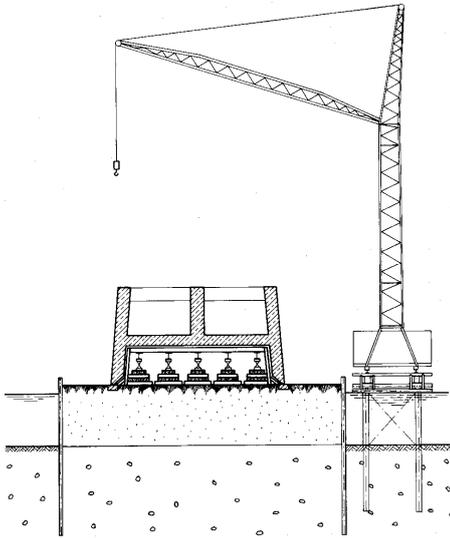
Herstellung eines Senkkastens auf einer künstlichen Insel [2]
